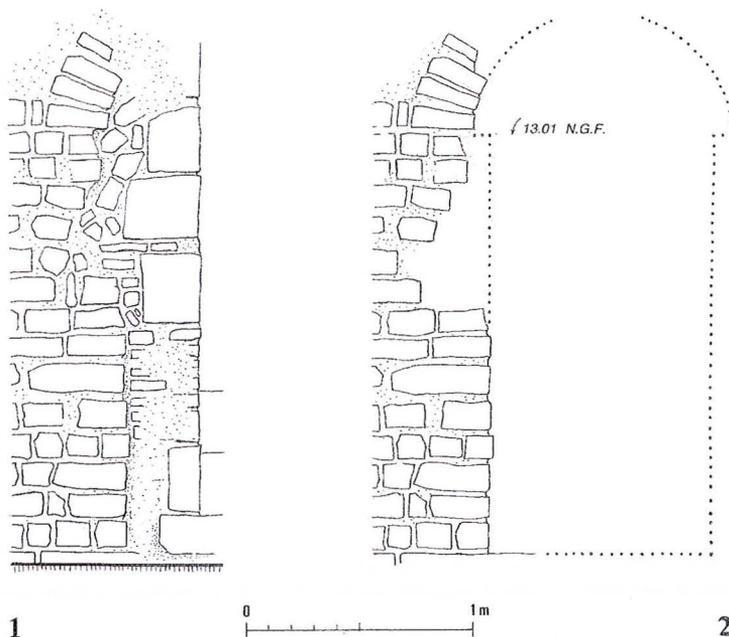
Rez-de-chaussée de la tour, intérieur, mur ouest. Élévation du parement conservé et restitution de la porte primitive.
